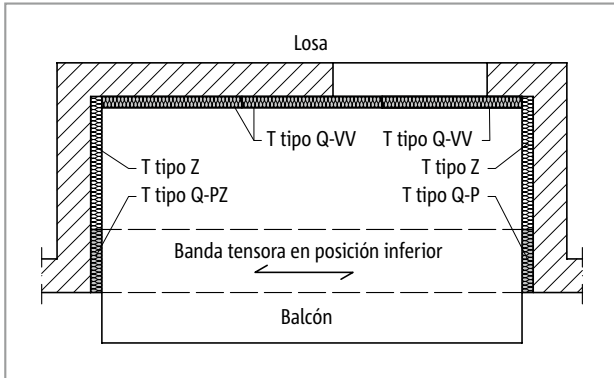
Schöck Isokorb® T tipo Q-VV, Q-P, Q-PZ: Logia con apoyo en tres lados y banda tensora
